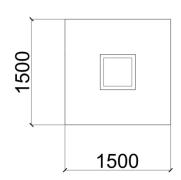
Фундамент под среднюю колонну
